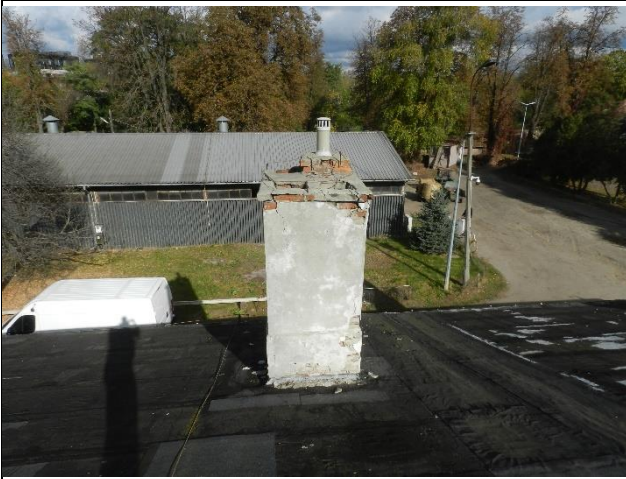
Widok pokrycia dachowego na połaci południowej.
